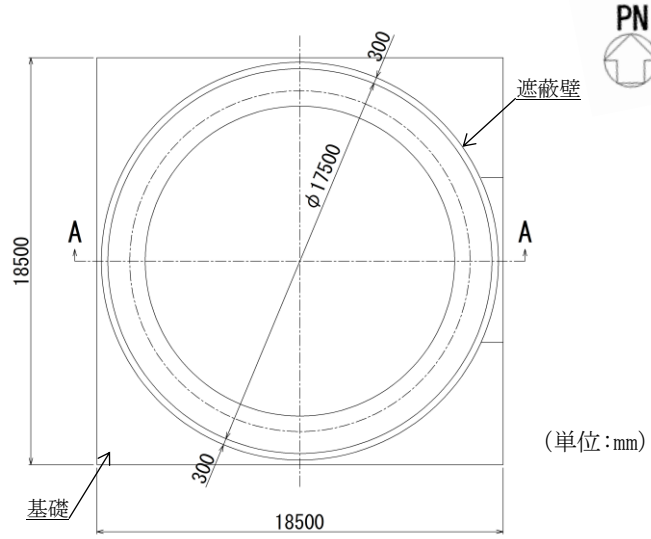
補助復水貯蔵タンク遮蔽壁 平面図
